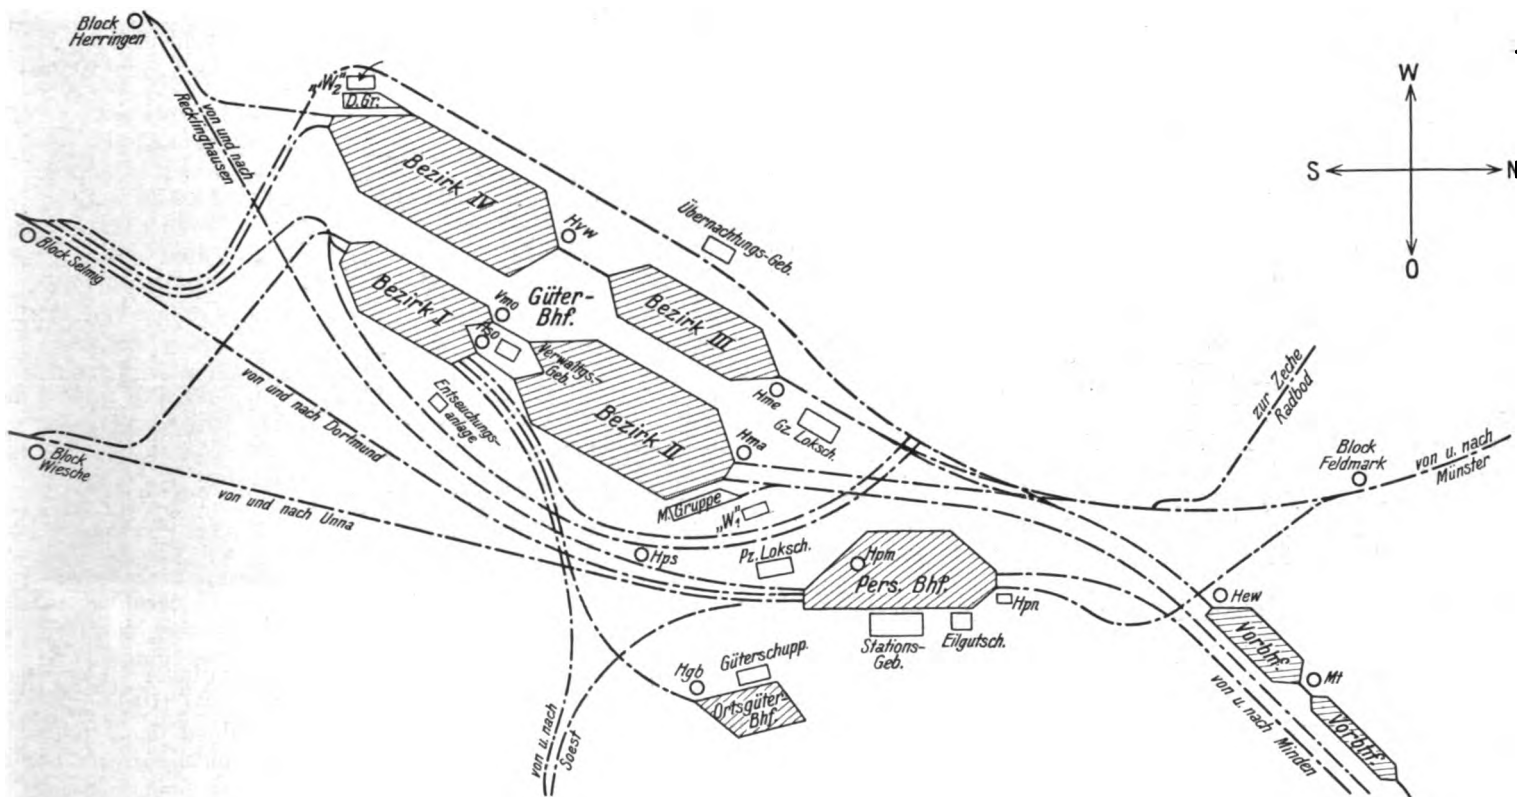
Lageplan des Bahnhofs Hamm i. Westf.
